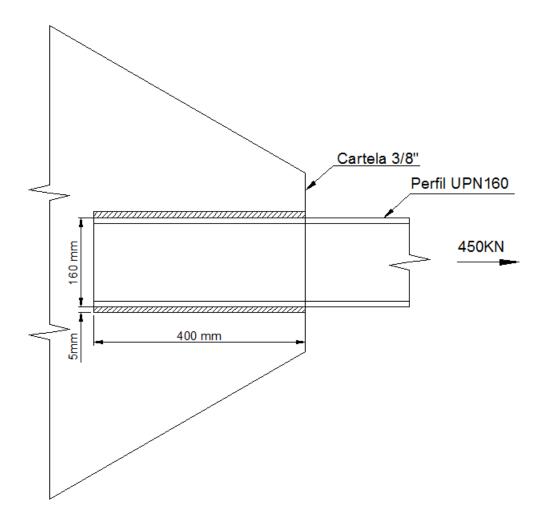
Unión soldada UPN160 con carga excentrica
